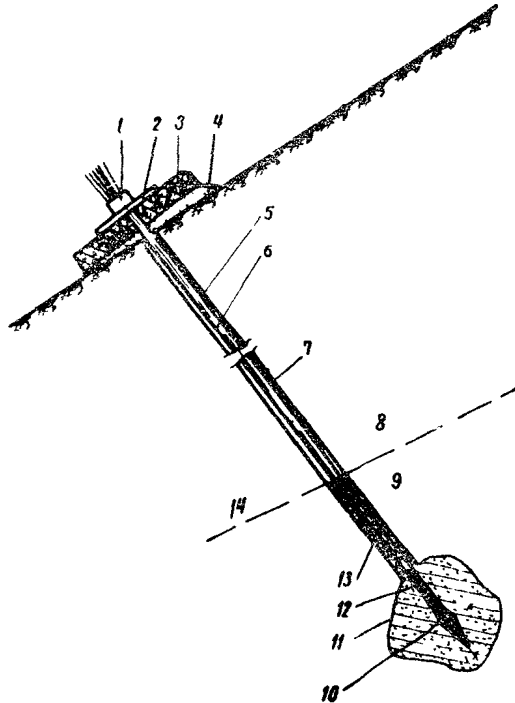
Конструкция анкерной затяжки: 1-верхний анкер; 2-распределительная плита; 3-бетонная плита; 4-щебень; 5-скважина; 6-трубка; 7-песок или битум; 8-оползневый грунт; 9-коренные породы; 10-нижний анкер; 11-камуфлетное уширение; 12-раствор; 13-пучок из высокопрочной проволоки; 14-плоскость скольжения
